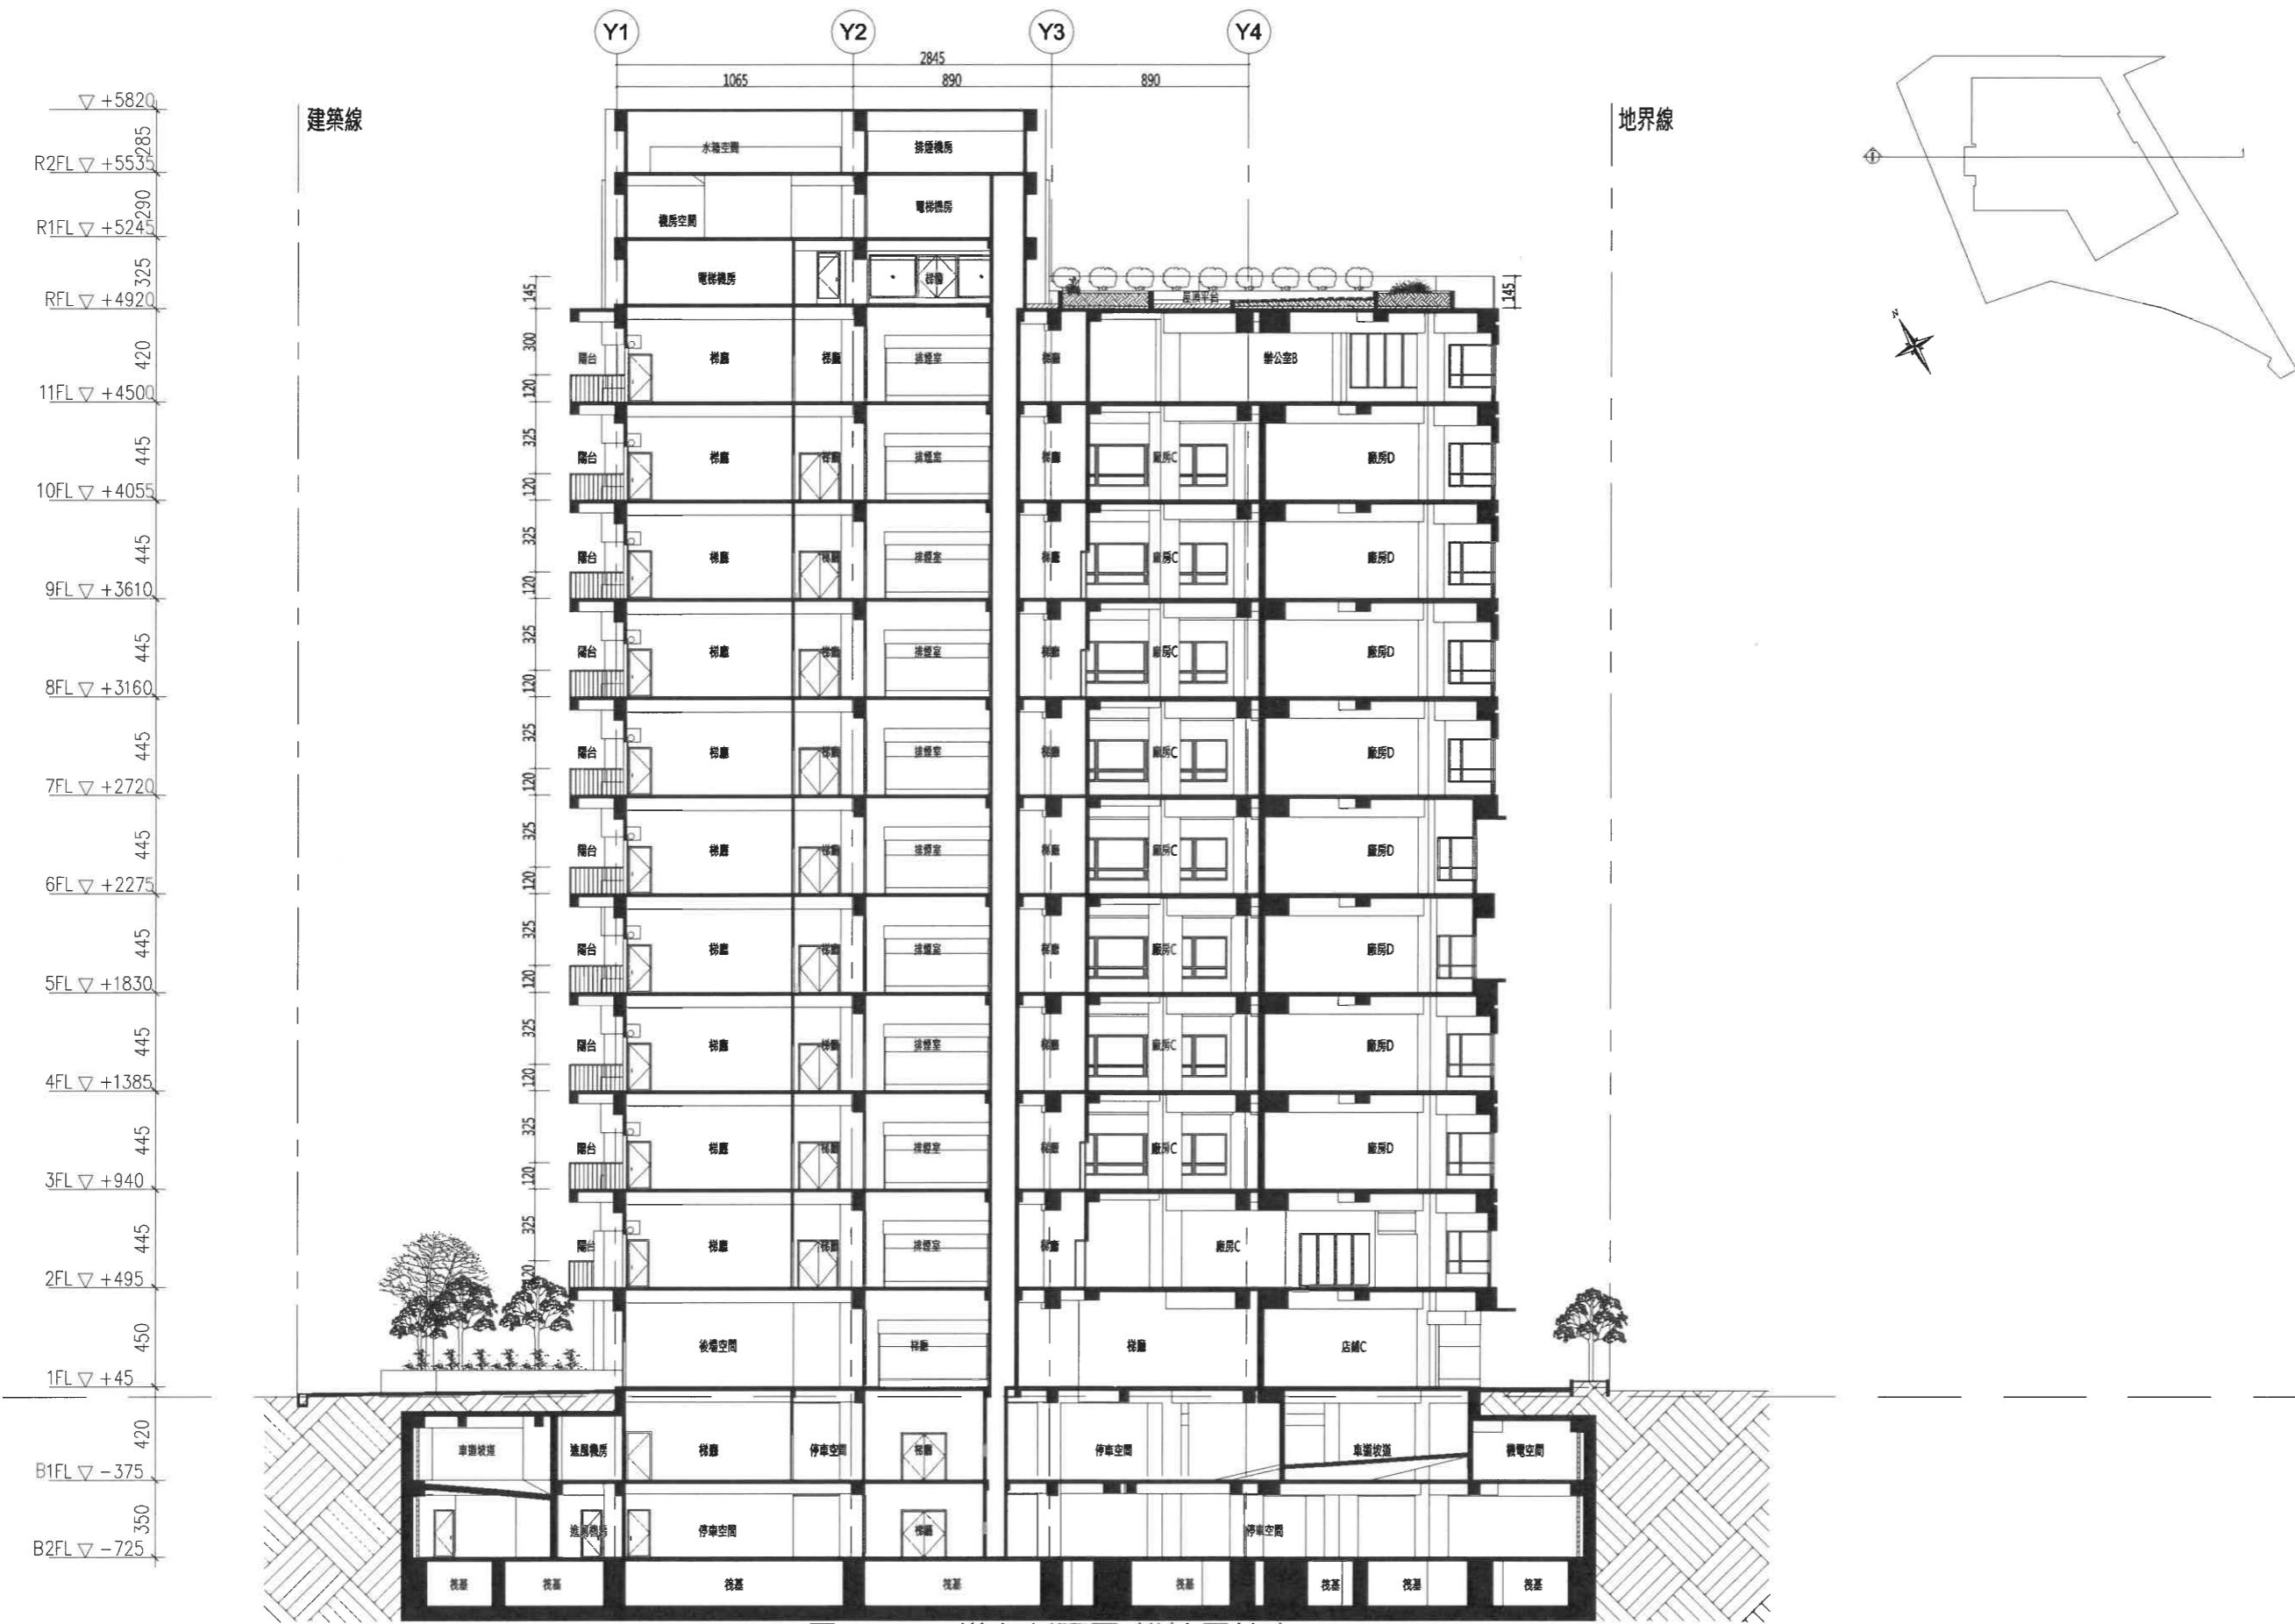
橫向剖面圖(維持原核定)(S : 1/300)
